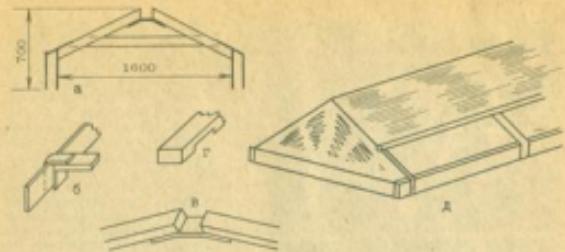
Укрытие разборно-пергольтовое: А — стропила для крепления боковых досок; Б — часть стропила и боковая доска в сборе; В — верхняя часть стропил с пазом для конькового бруса; Г — часть конькового бруса с пазом для крепления; Д — УРП в сборе
